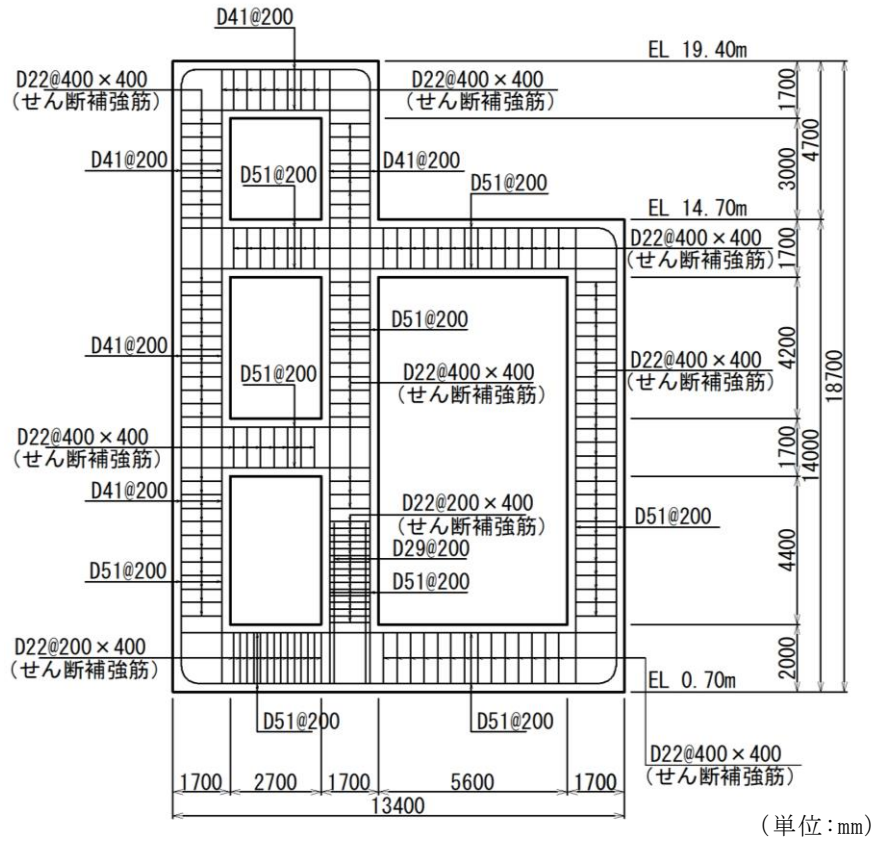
第 1 ベントフィルタ格納槽概略配筋図 (A-A 断面)
